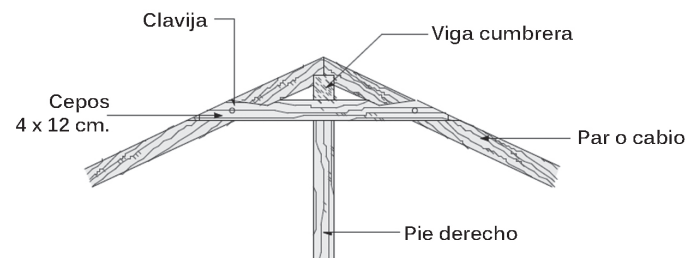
Detalle de ensamblaje de cepos mediante clavijas de madera.
